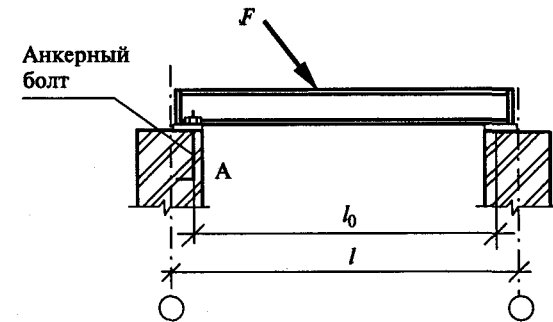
Крепление балки к опоре с помощью анкерного устройства
